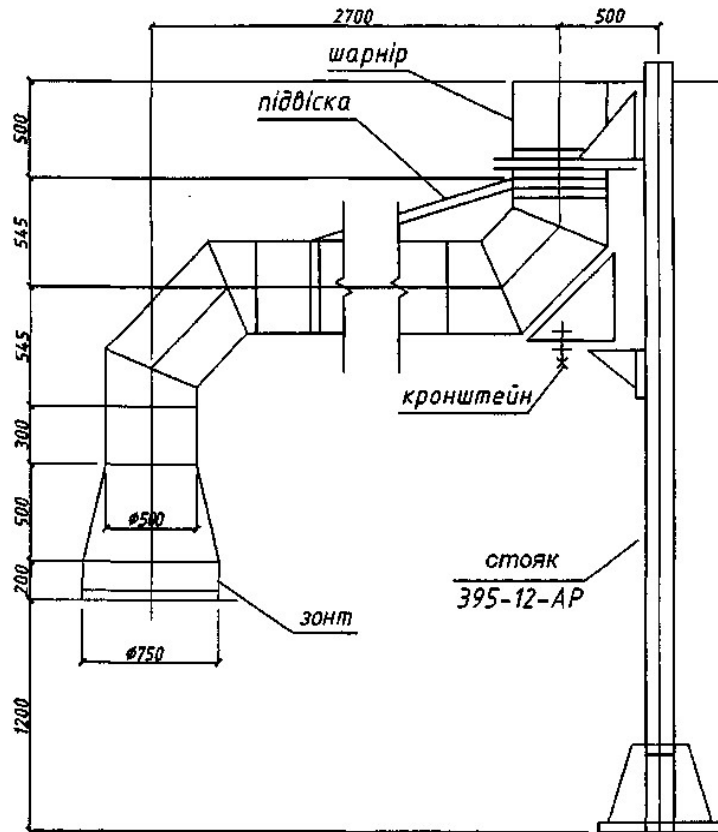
Конструкція витяжної вентиляції марки С5.45-3.0,
